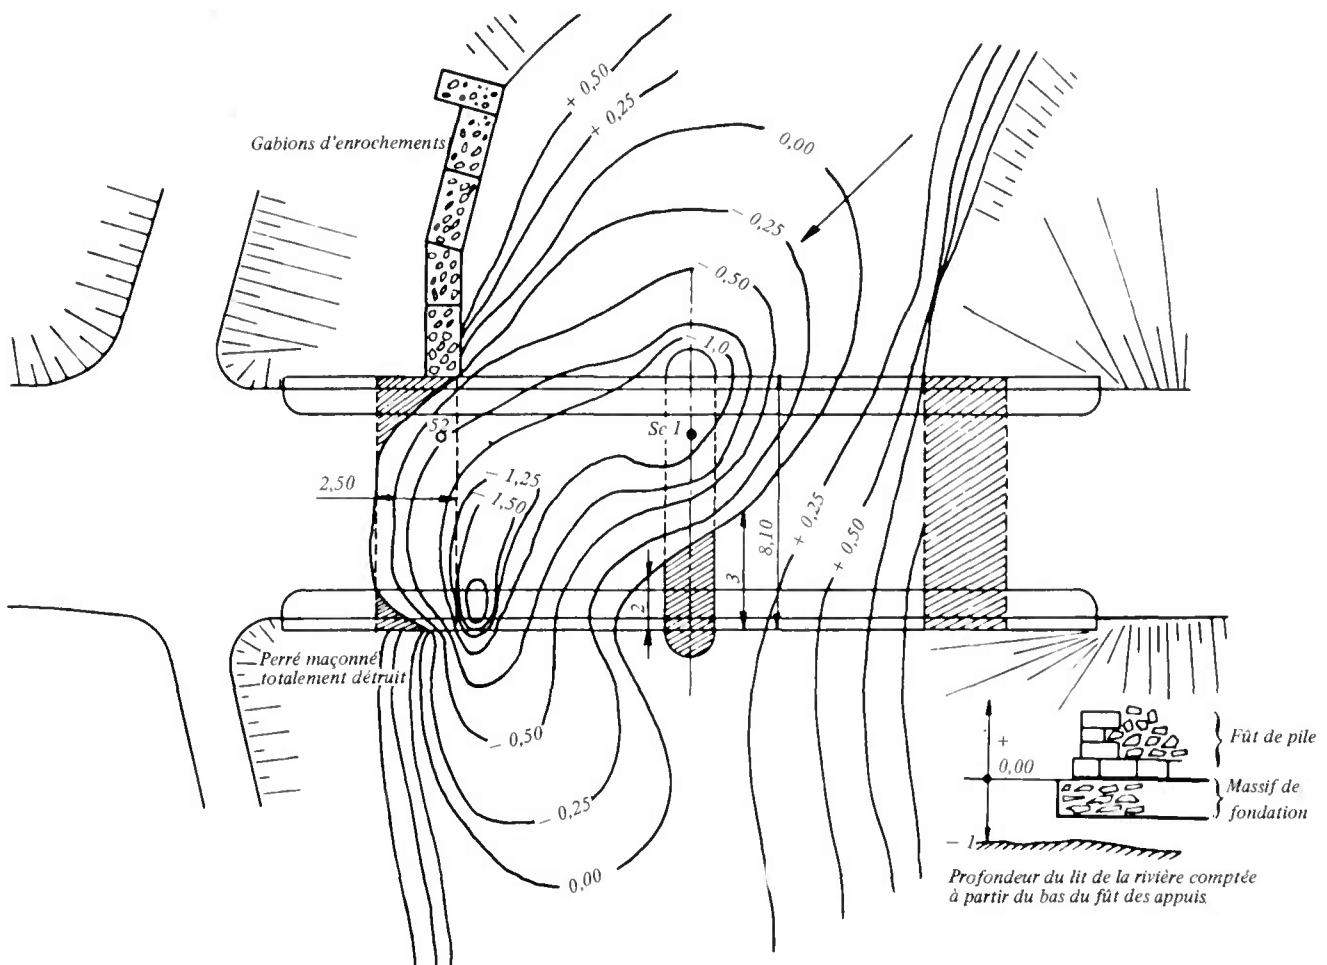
Affouillement d'une fondation sur schiste. Pont de Régereau.
